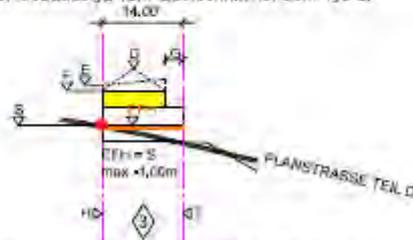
Auszug aus dem Bebauungsplan "An der Sündelt"; Quelle: momentum:bau GmbH
